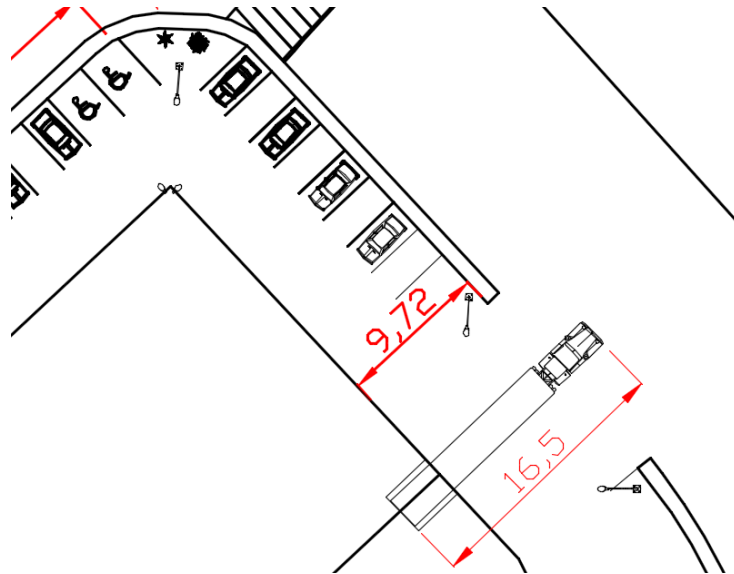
Detalle plano parcela. Disponible en Anejos. *Cotas en metros
